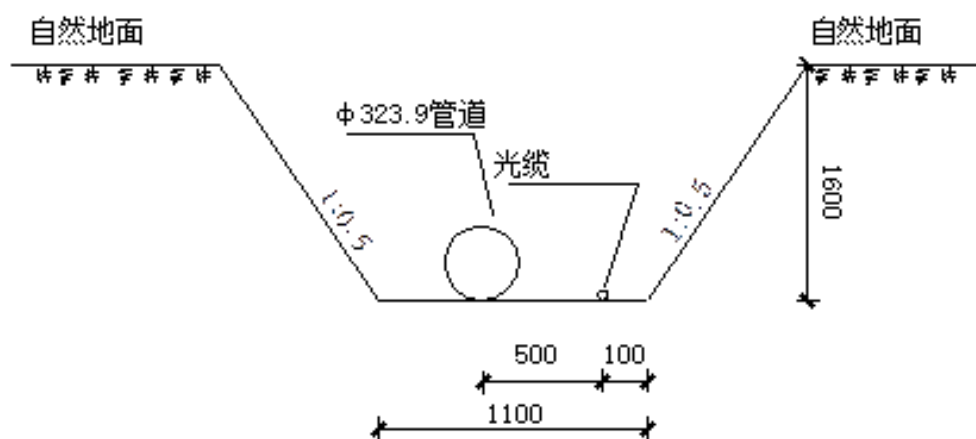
标准管沟端面尺寸示意图 (mm)
